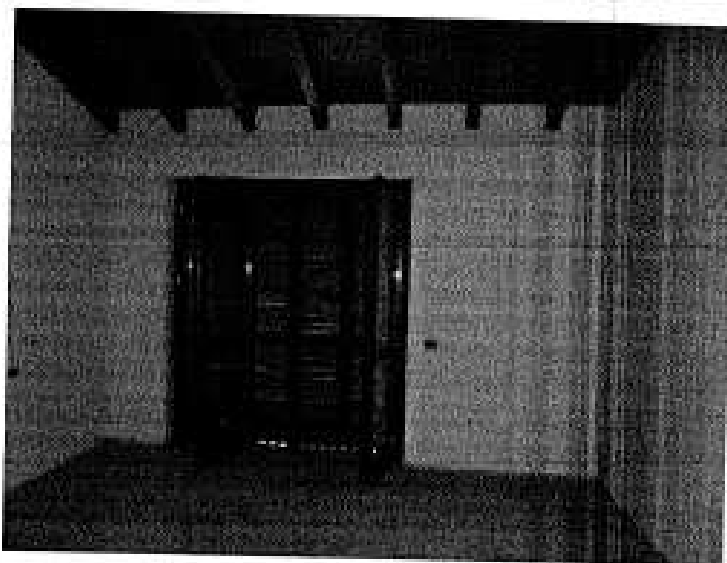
Blocco -d-: Bagno Villetta P.1:
